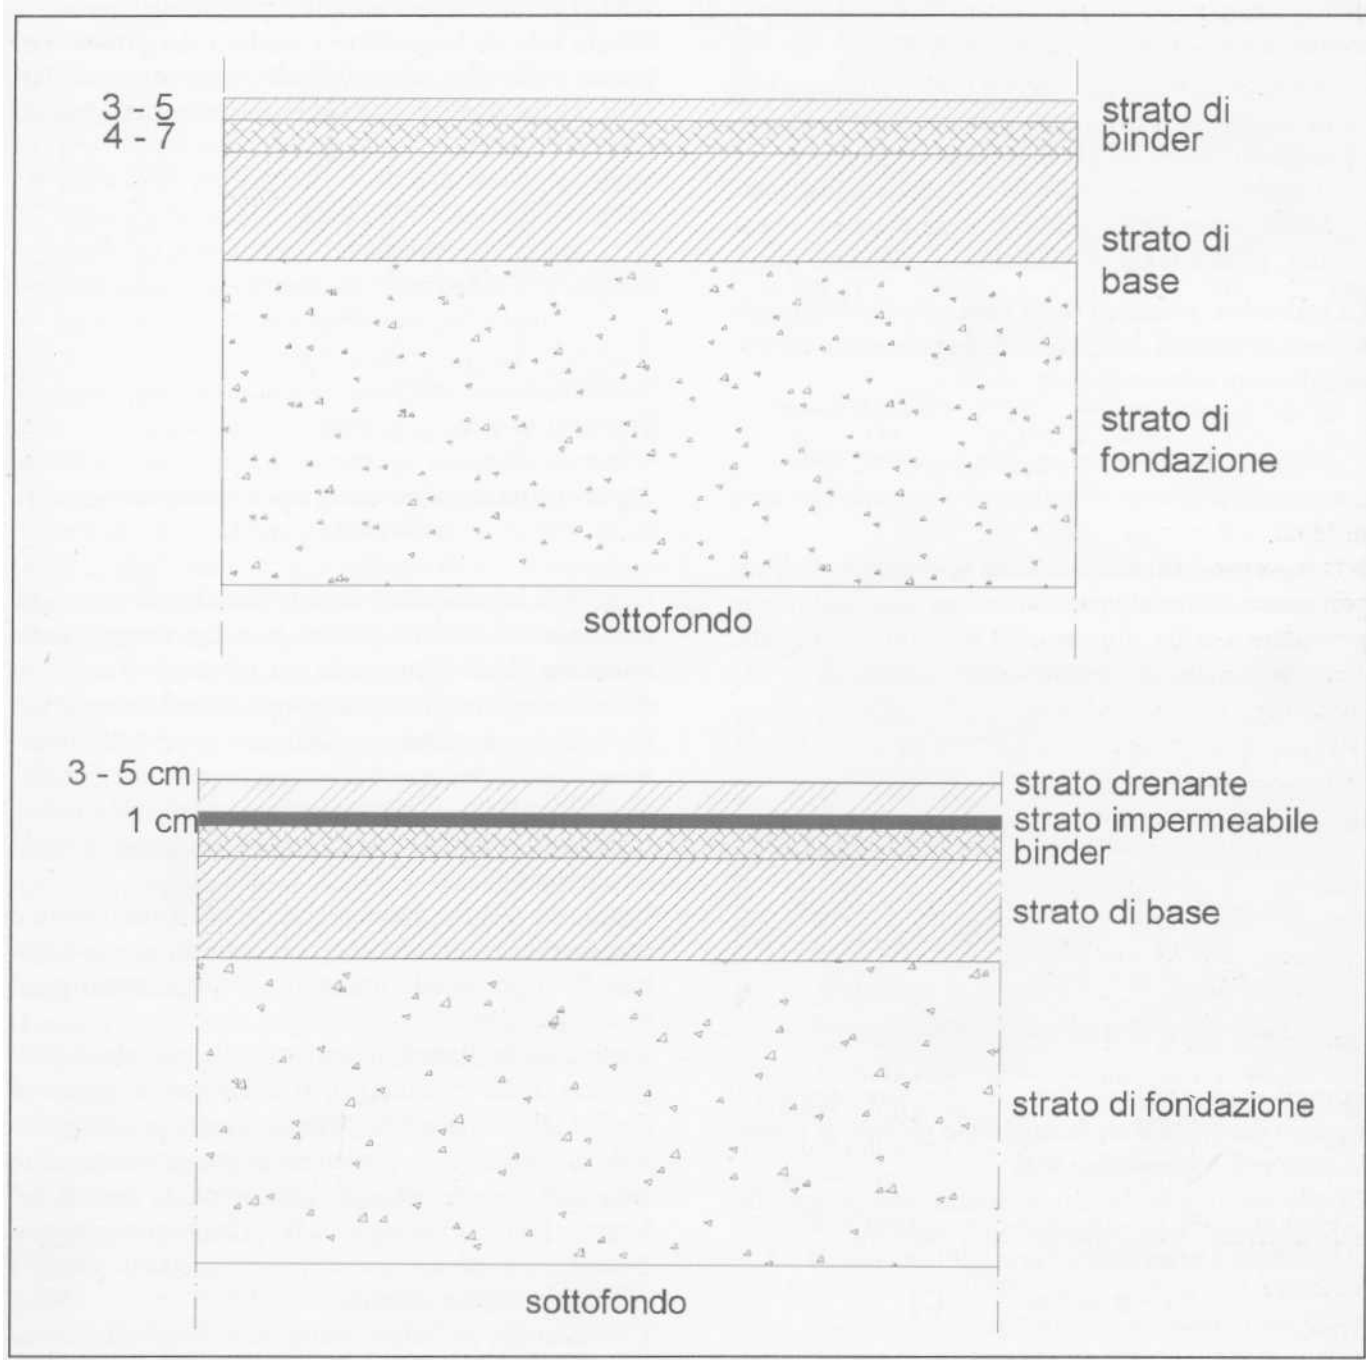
e 6 - Schema strutturale di una pavimentazione convenzionale (sopra) e di una drenante (sotto)
